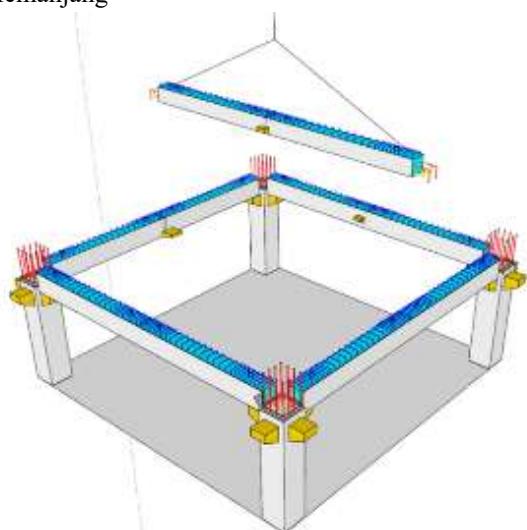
Proses Pengangkatan Elemen Balok Induk Beton Pracetak
